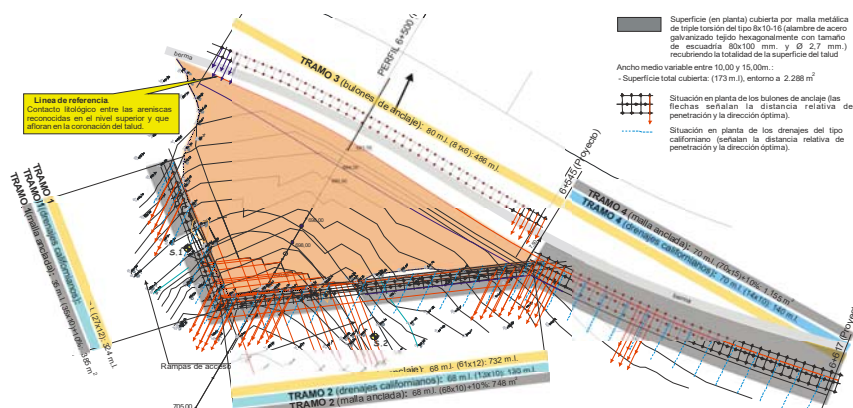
Situación en planta de las medidas de contención diseñadas para el talud
